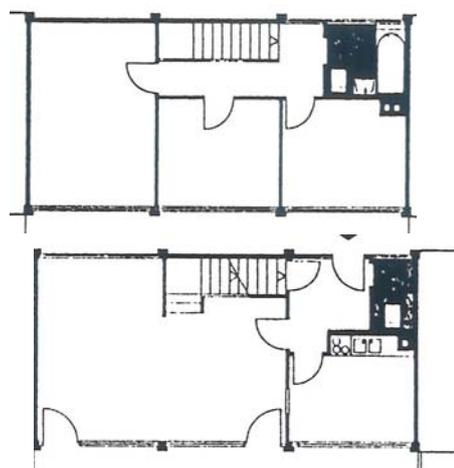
Grundrisse Reihenhäuser EG unten, OG oben
